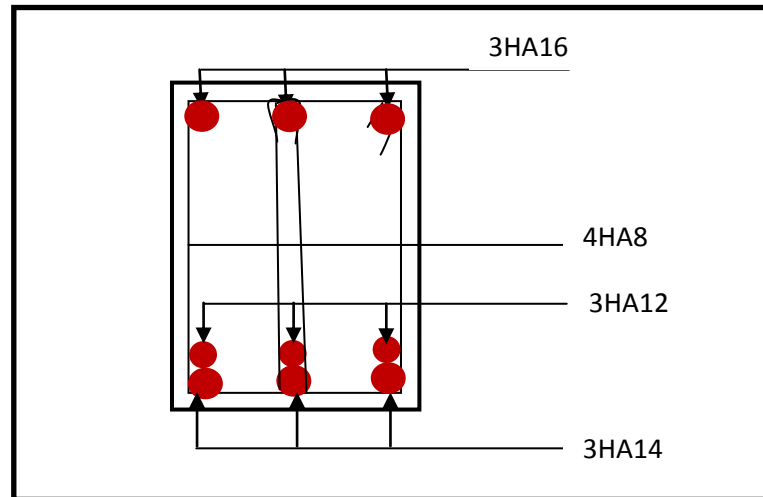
Ferrailage en travée d'une poutre principale.
